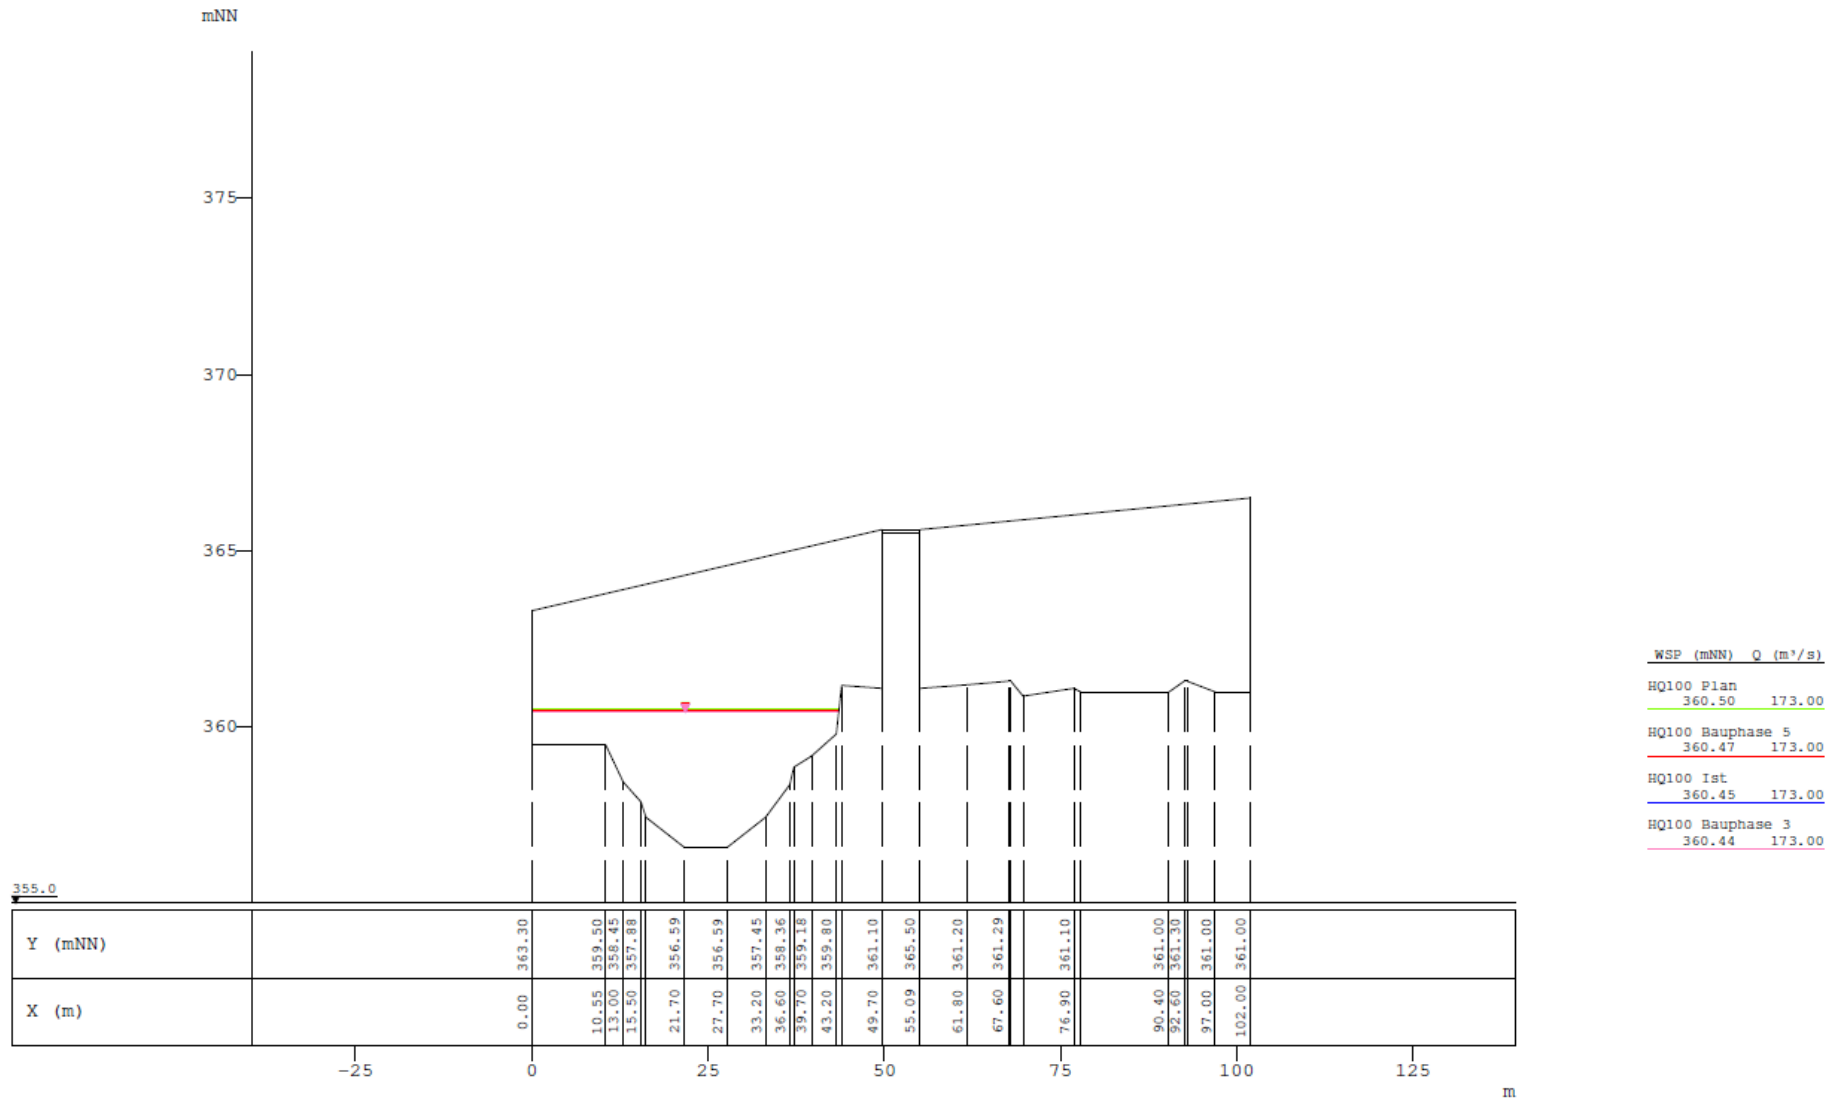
Querprofil 82100 (Brücke B410) inkl. Wasserspiegellagen HQ100 Istzustand, Planzustand, Bauphase 3 und Bauphase 5; Geometrie Planzustand
